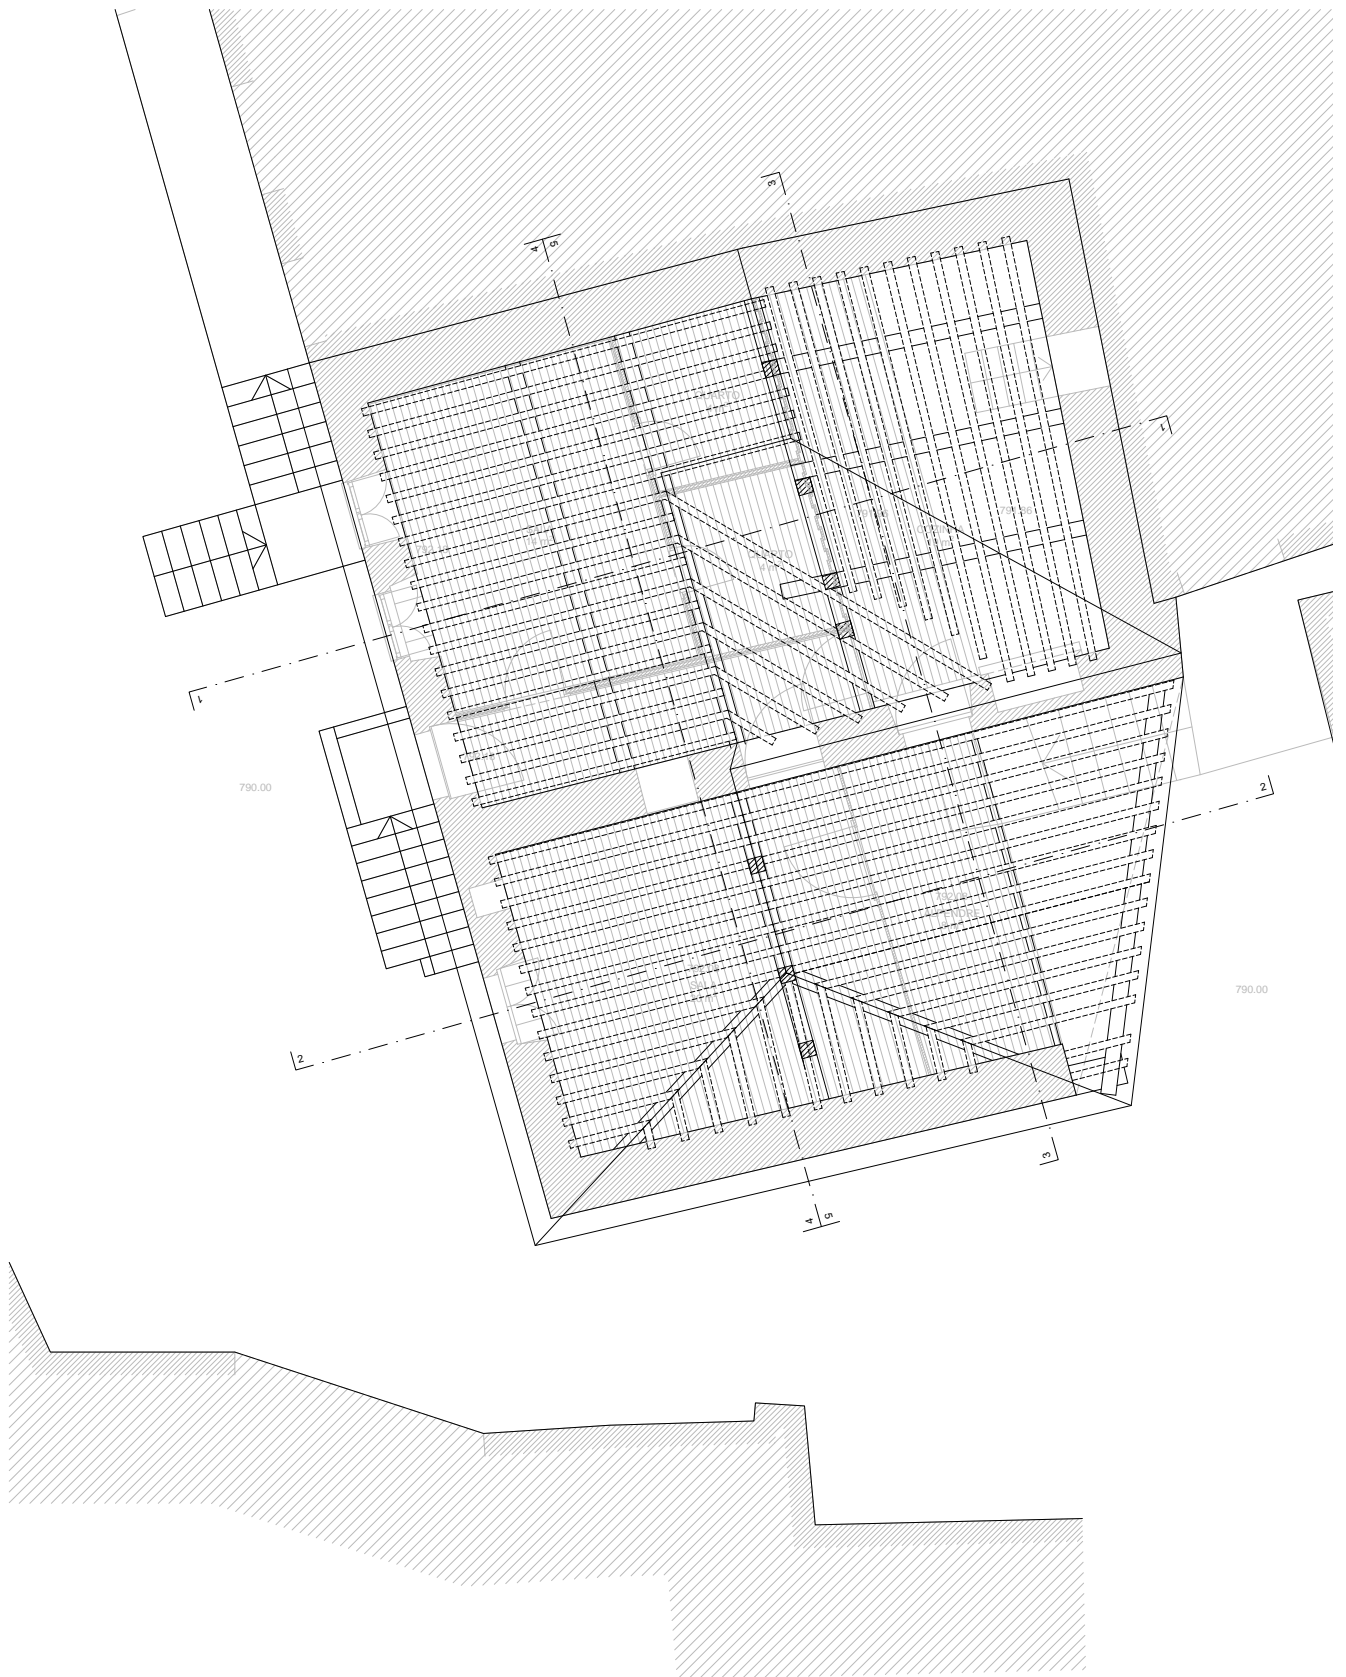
Levantamento esquemático da atual cobertura. Escala 1:100.
